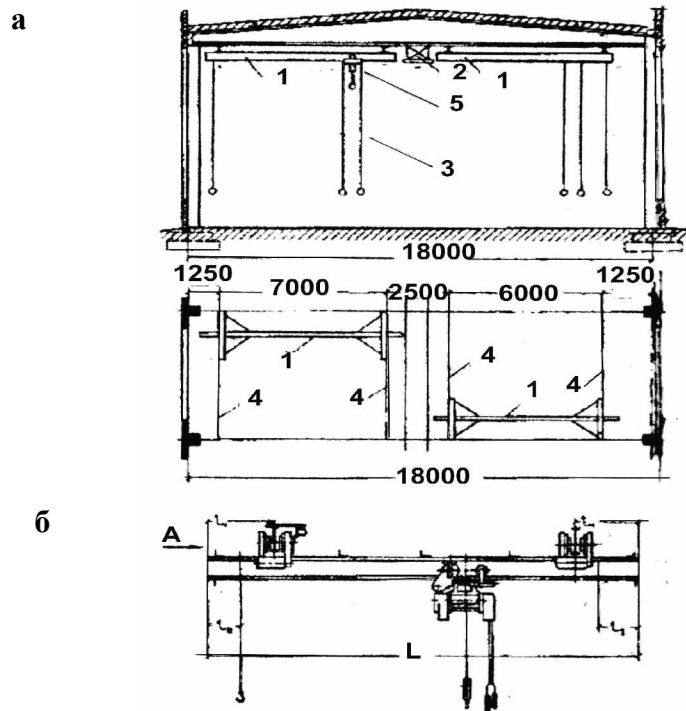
Поперечный разрез производственного здания с мостовым опорным краном.
